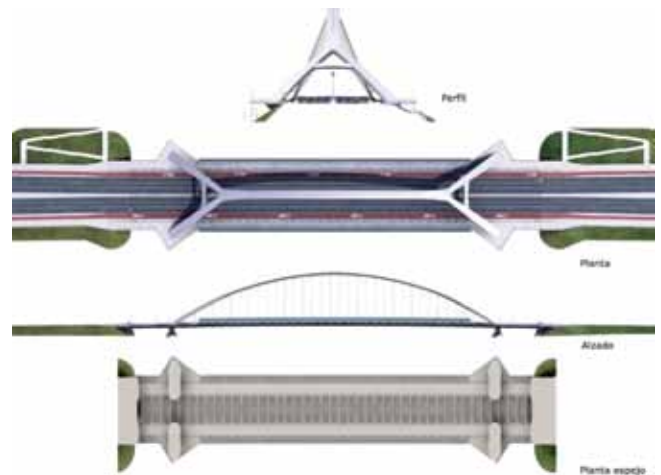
P3M. Alzados y plantas del puente del Tercer Milenio
